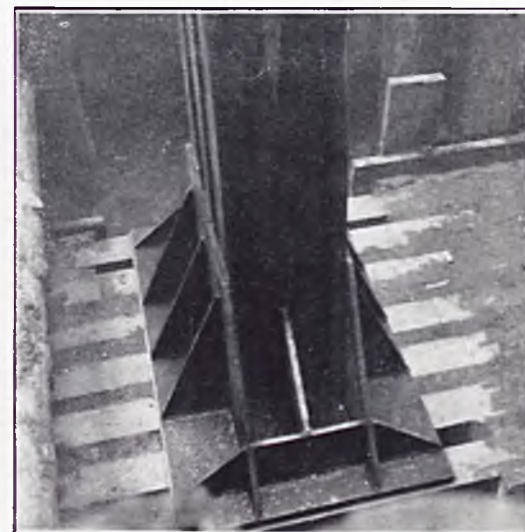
Colonne sur les poutres des fondations soudées bout-à-bout.
